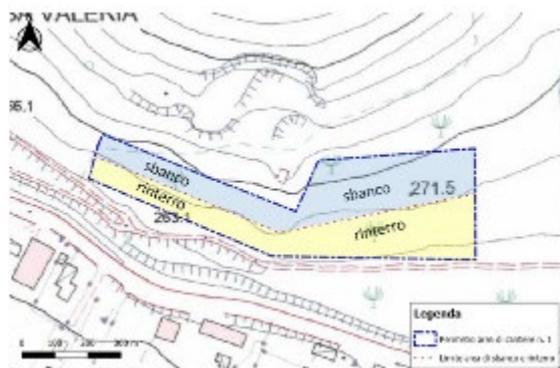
Aree di scavo e riinterro in corrispondenza del cantiere del pozzo PZ1.
